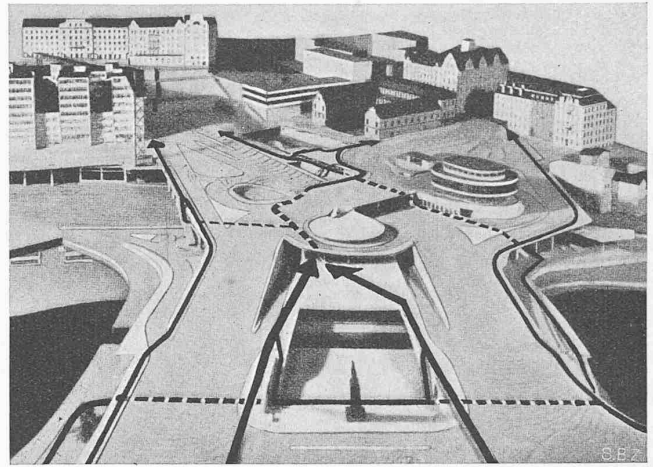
Modellbild des «Slussen» aus Norden mit Eintragung der Fussgängerwege: voll offen, gestrichelt in Tunneln. Der Restaurantbau in der westl. Schlinge ist noch nicht ausgeführt.
